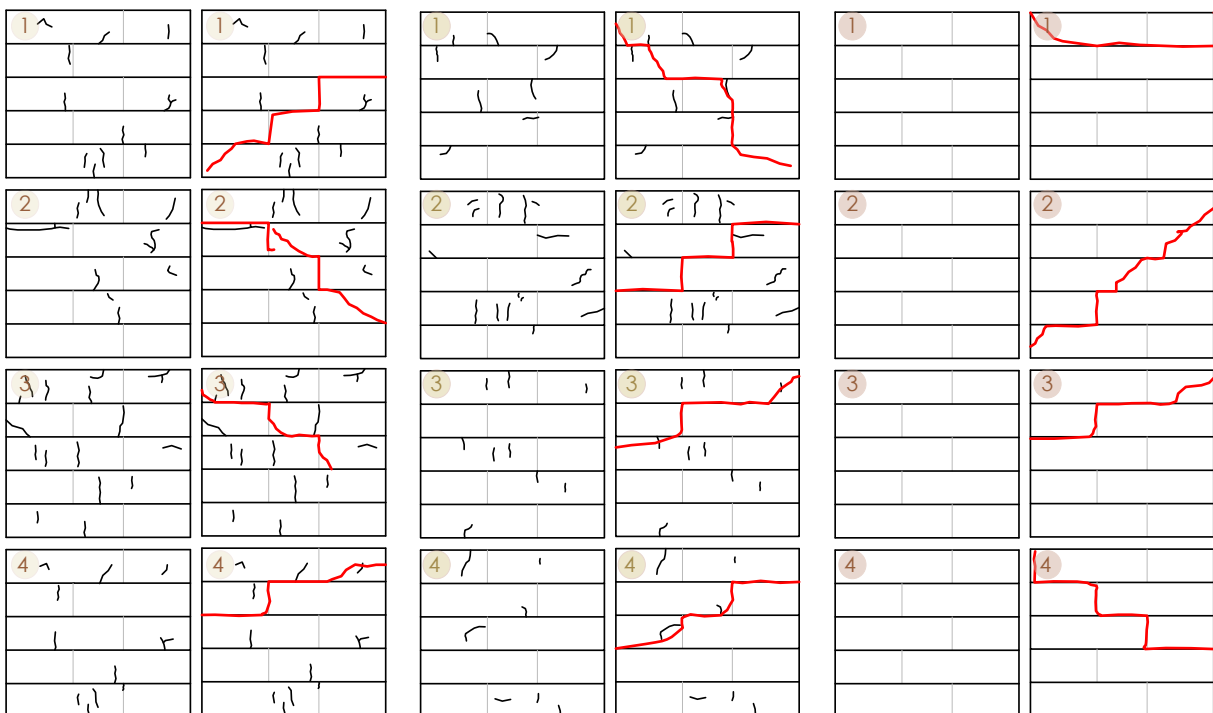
Fisuras y fallas de las muestras en el ensayo de muretes a compresión diagonal
